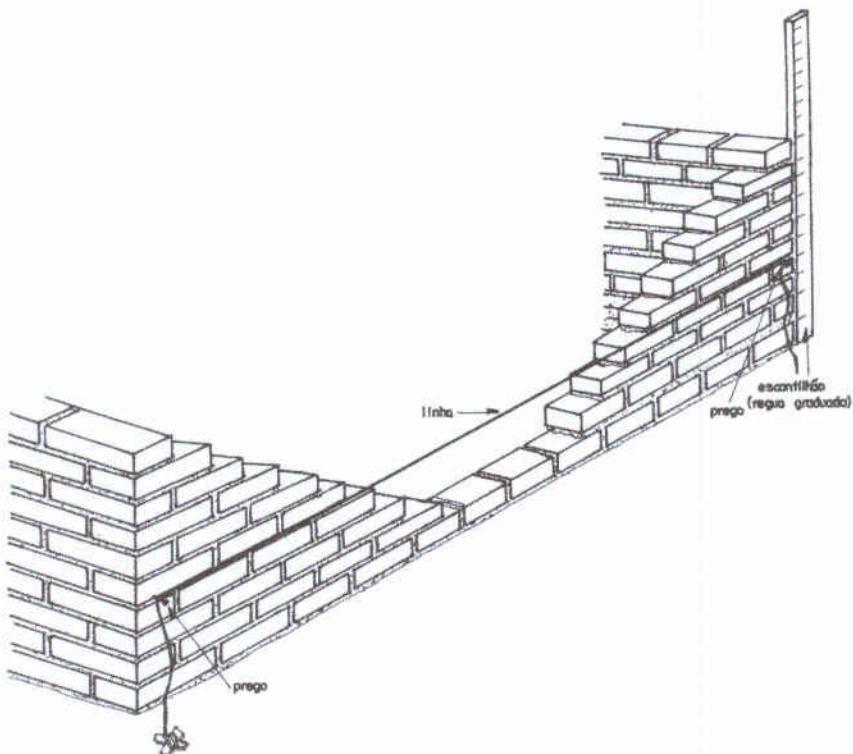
Detalhe do nivelamento da elevação da alvenaria.
